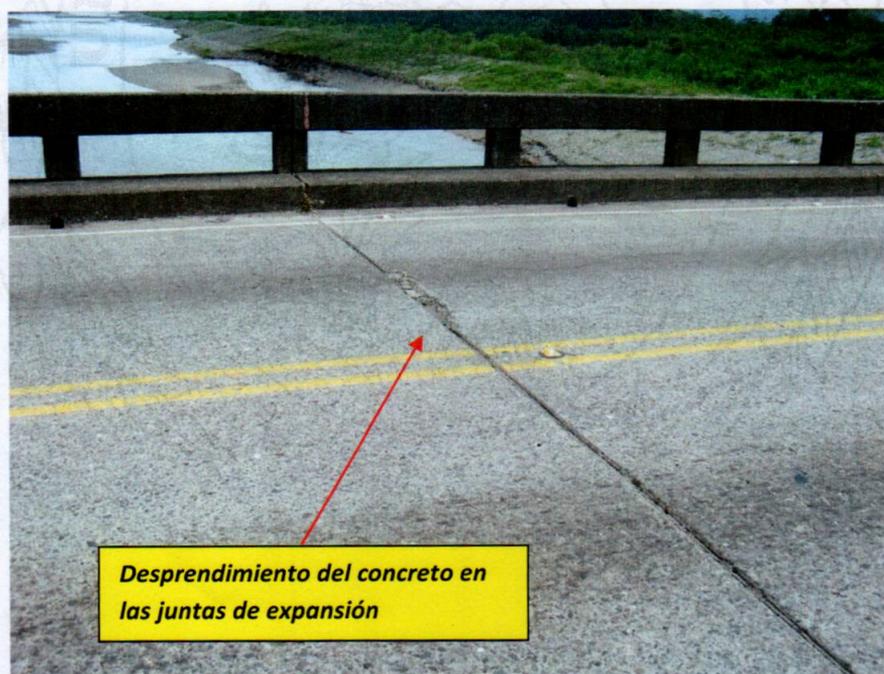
Desprendimiento del concreto en las juntas de expansión.
